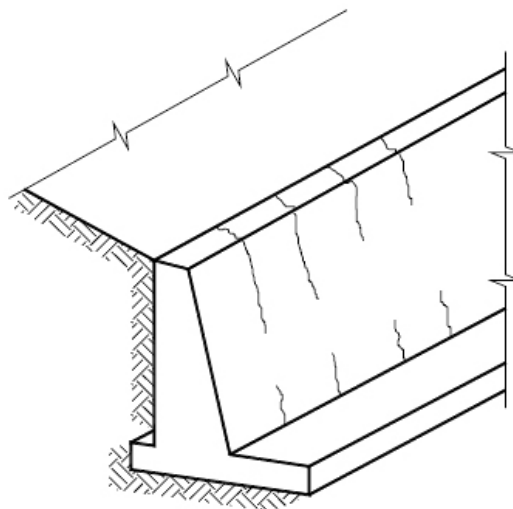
Fissuras de retração por secagem muros de arrimo. (IPR Publicação, 709 – 2004).
